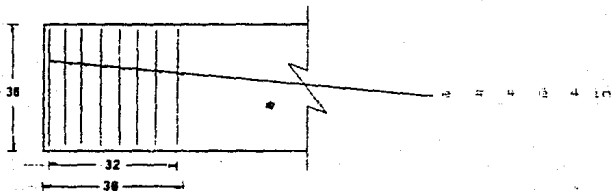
Croquis de armado para los extremos de la viga del probeta testado
